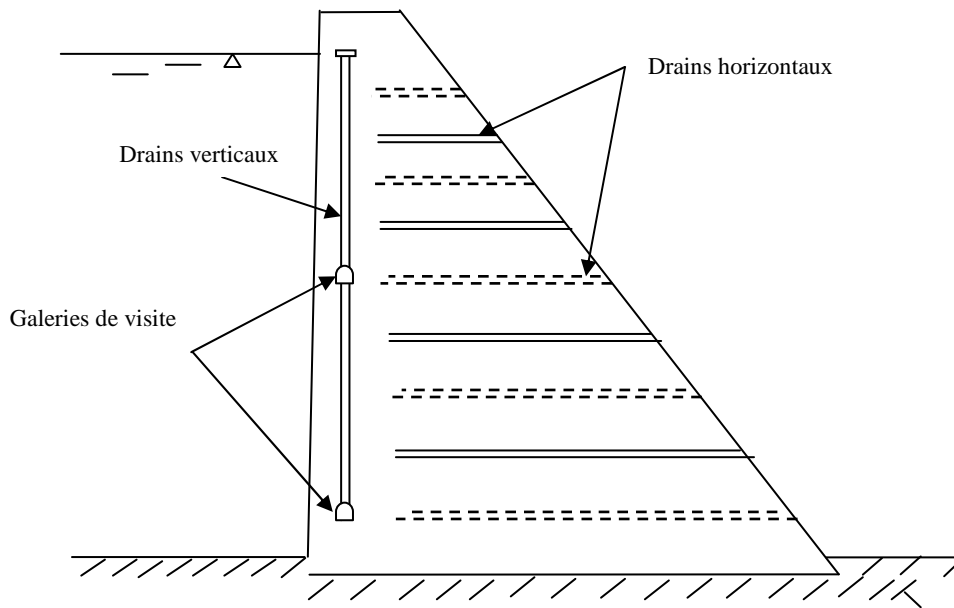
Coupe du barrage montrant le réseau de drainage horizontal.
